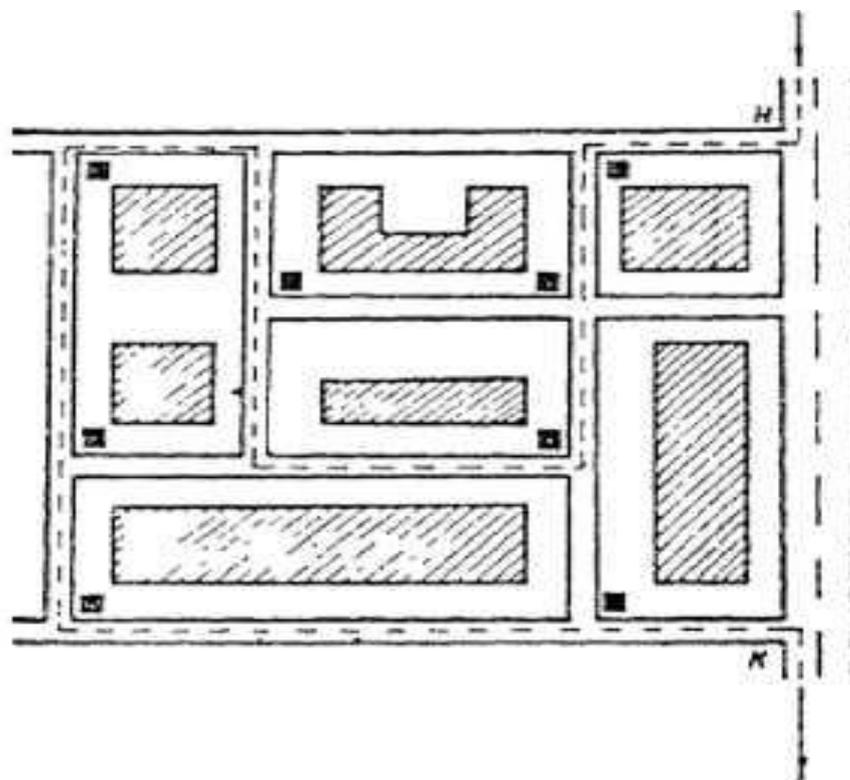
Схема участка сбора – места установки контейнеров
